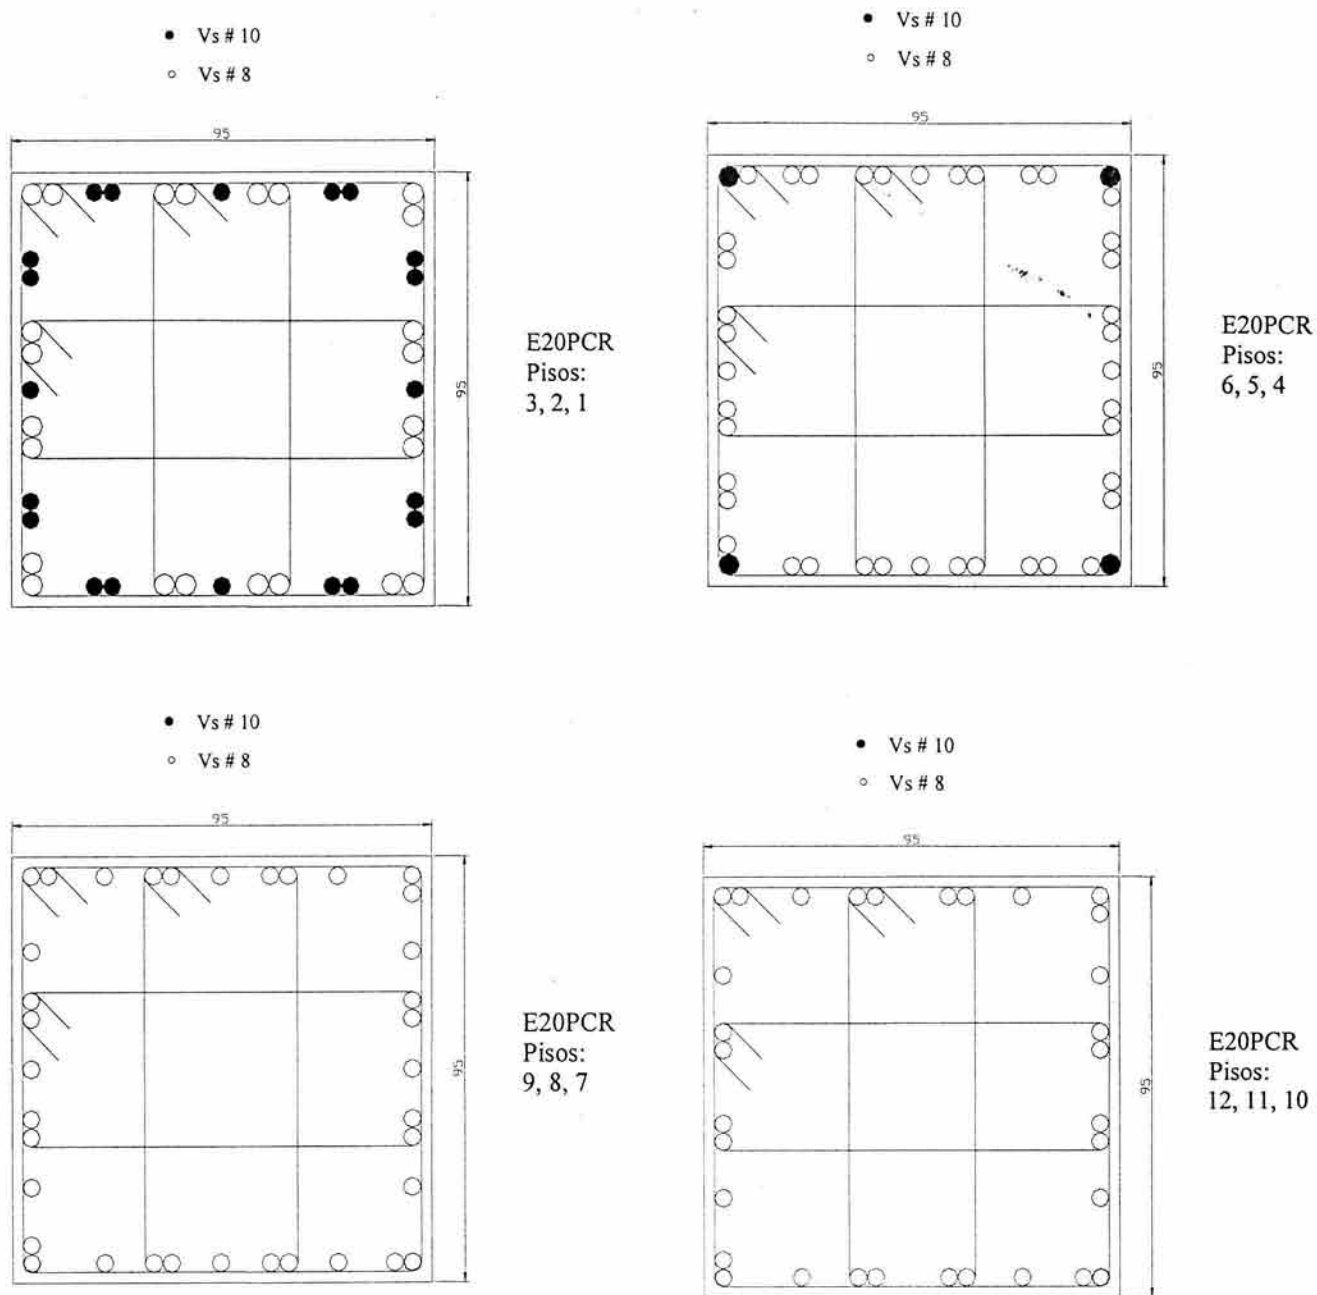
Detallado de columnas en edificio de 20 niveles, marcos exteriores.
